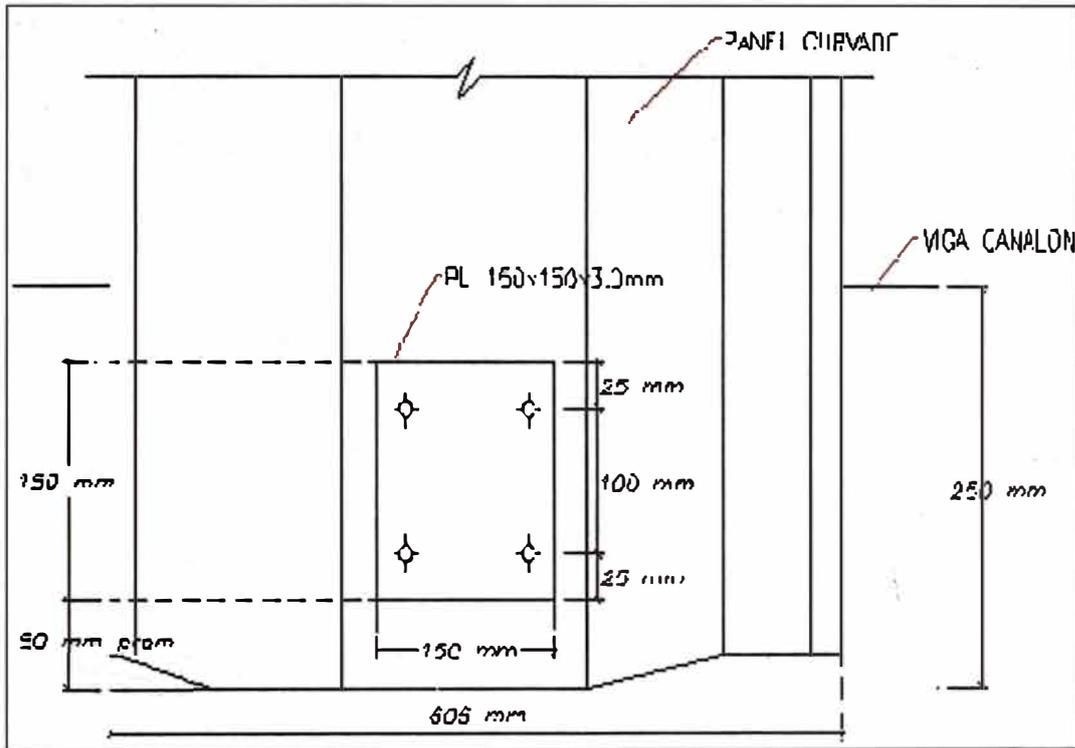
Vista en planta de anclaje en viga (Referencia 3)
